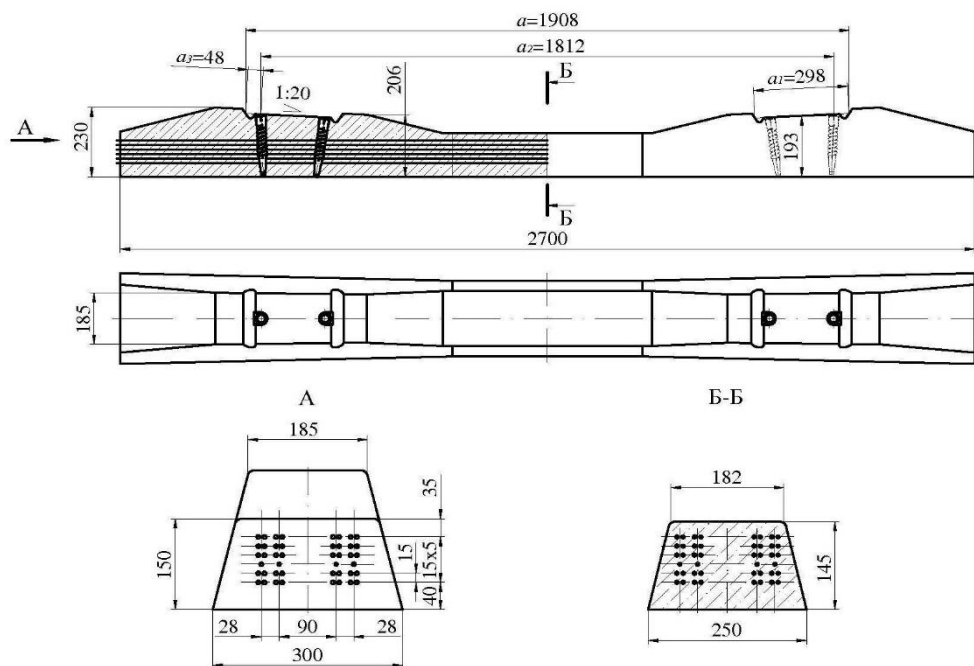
Шпала залізобетонна попередньо напружена типу SH.
